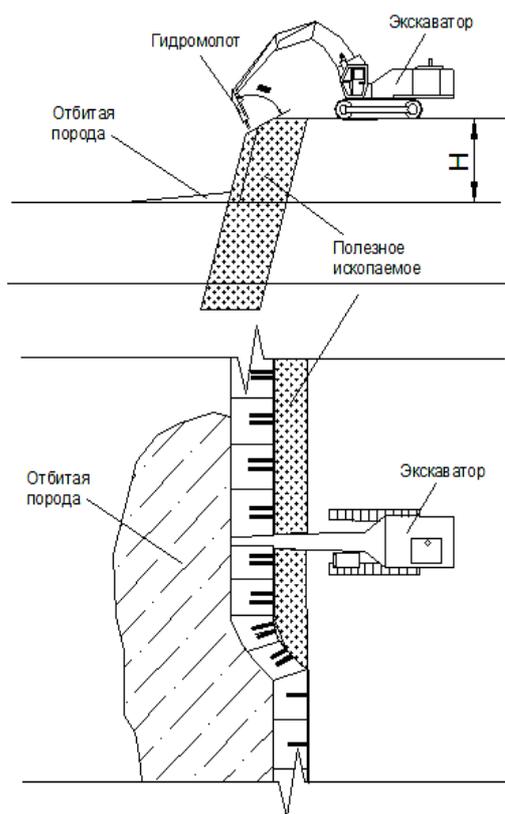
Обработка уступа с верхней постановкой гидравлического отбойного агрегата
